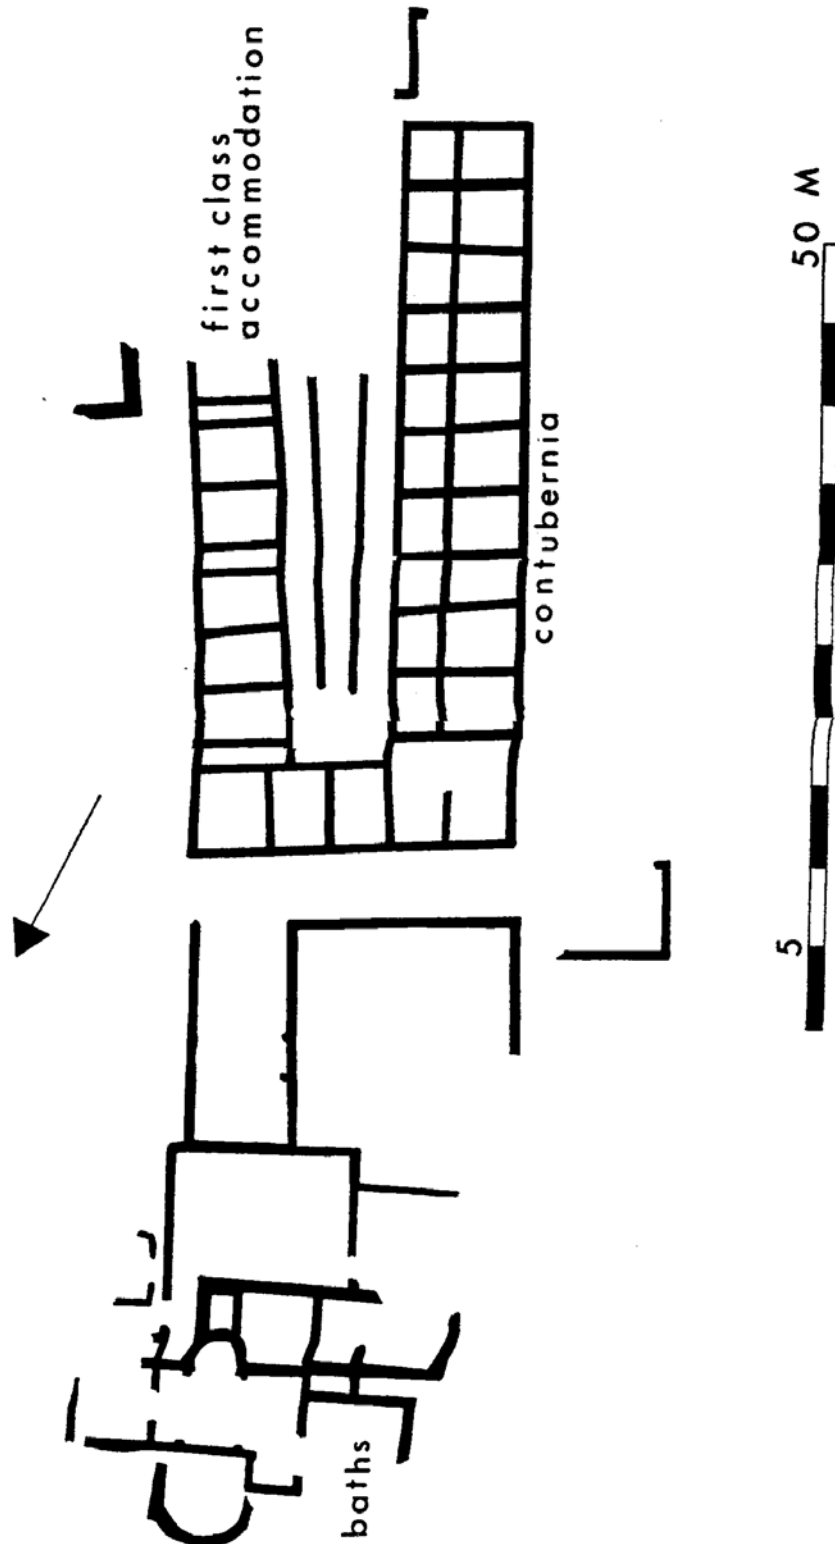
Vindonissa*, planta de las estructuras termales y de alojamiento.
